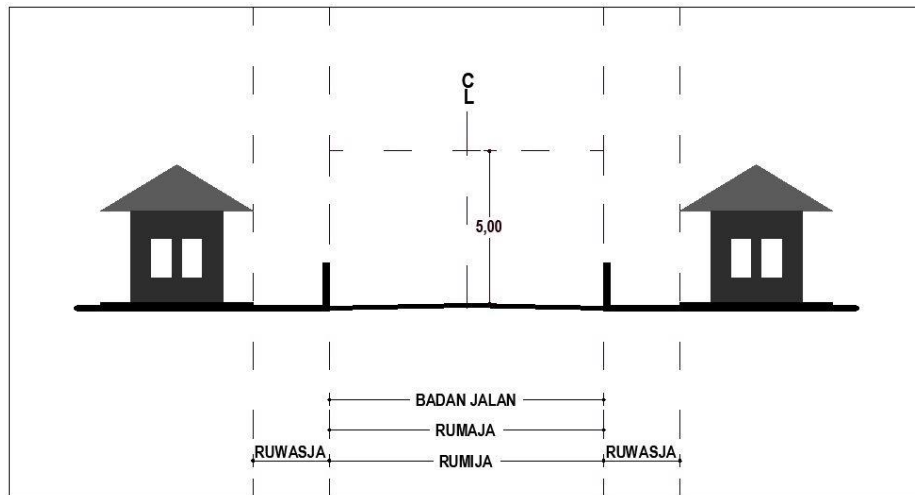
Penempatan Bangunan dan Jaringan Utilitas di Bawah Tanah di Ruang Milik Jalan Tipe 4
